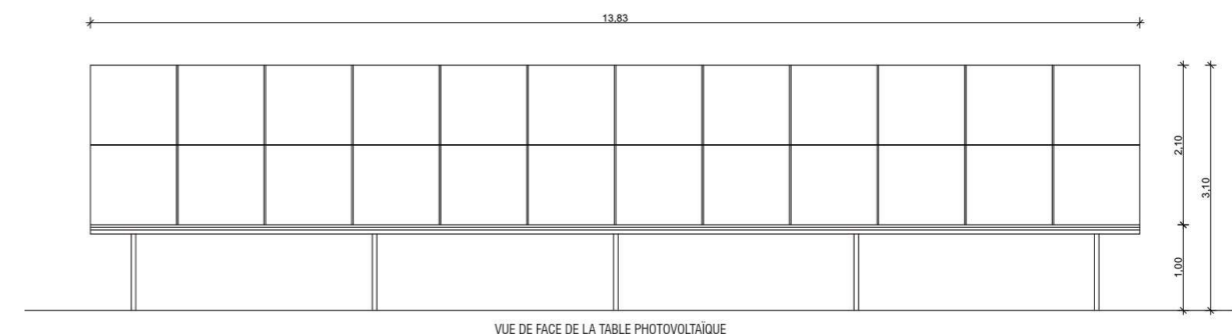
Vue de face d'une grande table photovoltaïque (24 panneaux) sur pieux battus
